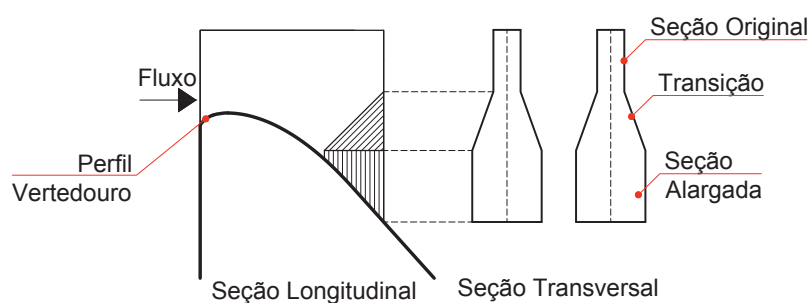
VERTEDOURO DE PANJIAKOU - PILARES ALARGADOS DE SEÇÃO RETANGULAR
